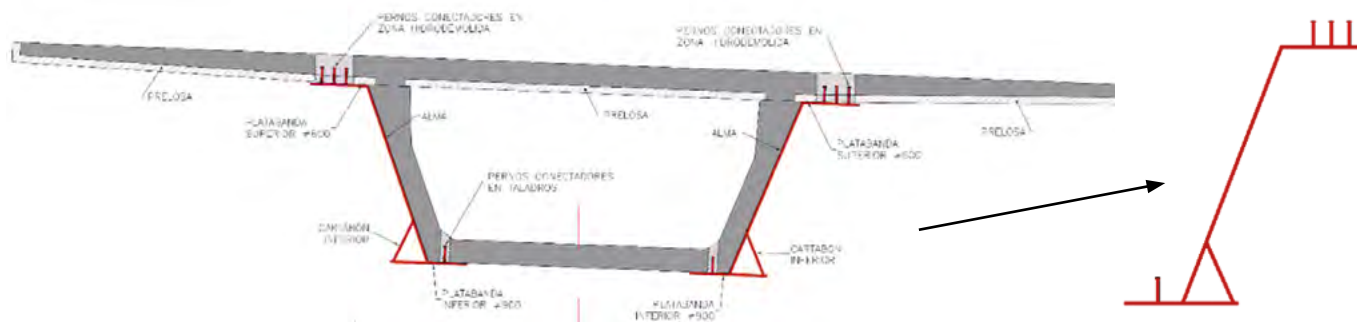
Sección transversal tipo de la solución propuesta y detalle de sección tipo del refuerzo metálico.
